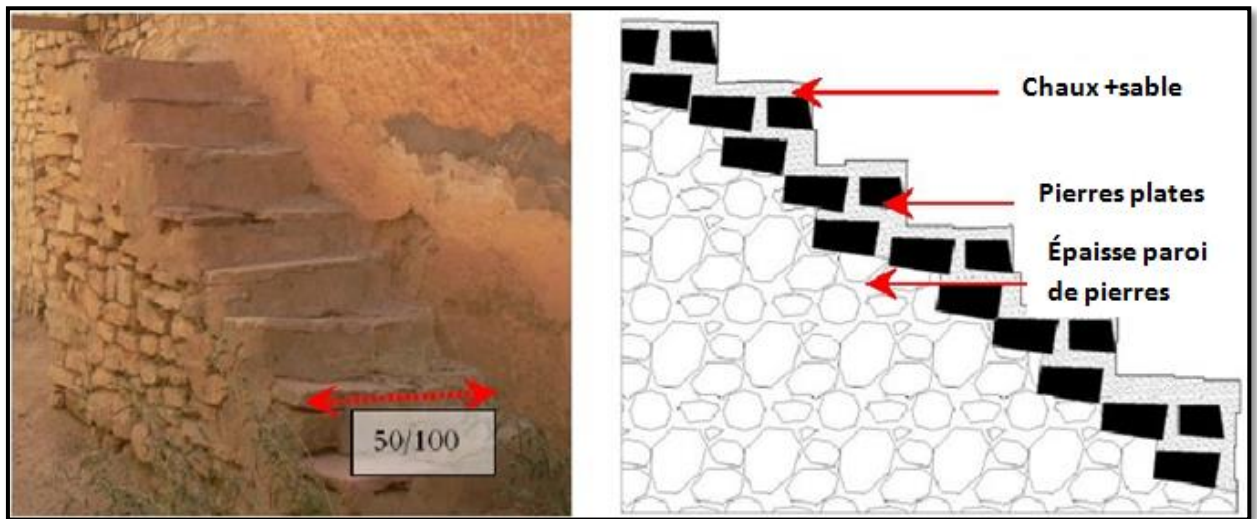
Coupe schématique des escaliers type 2. (Source par l'auteur)
